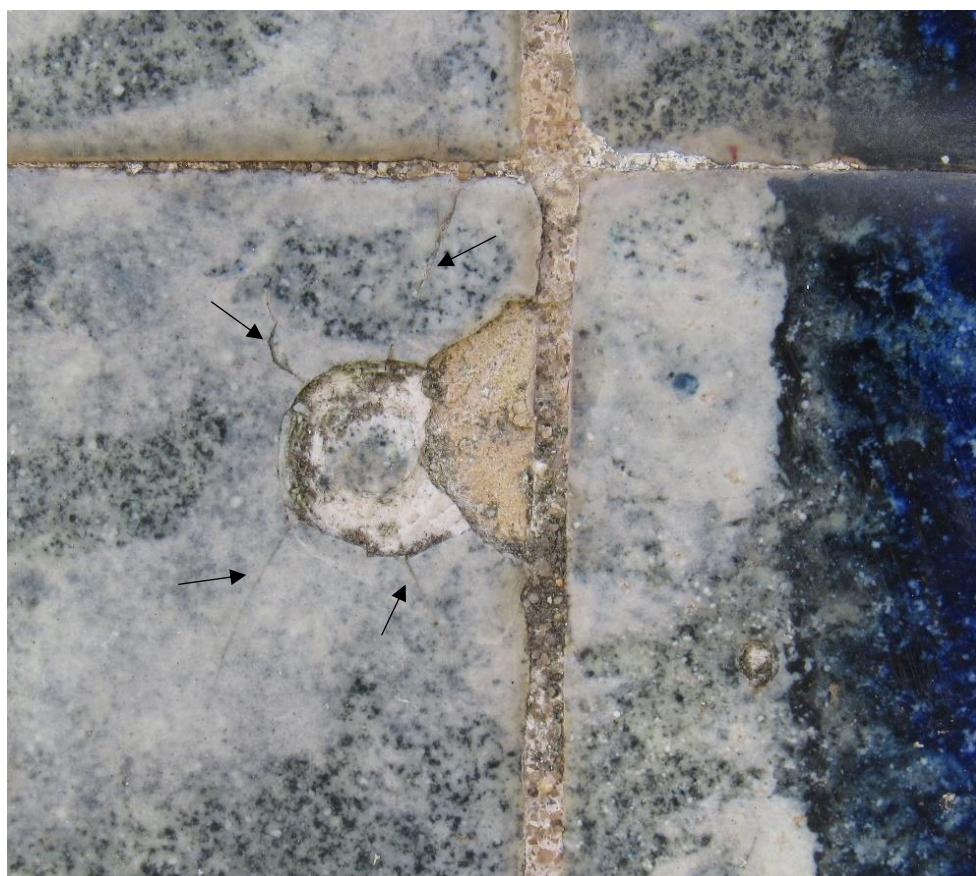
Punção que origina fissuras radiais levando ao destacamento de vidrado
